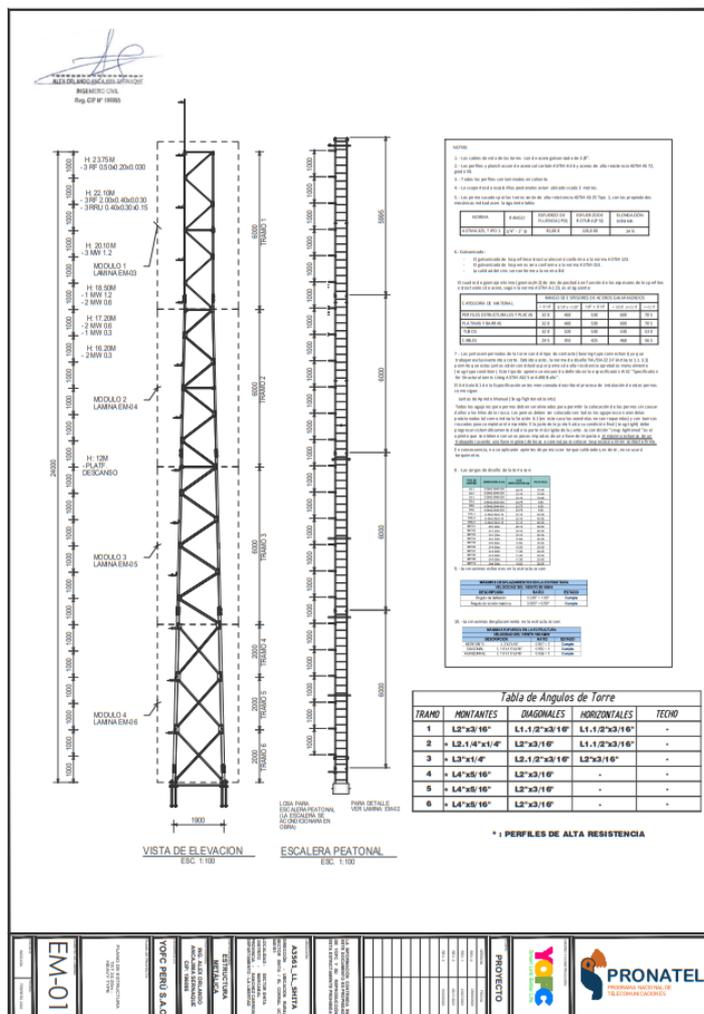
Plano de estructura metálica- A3561\_LL\_SHITA- 01
